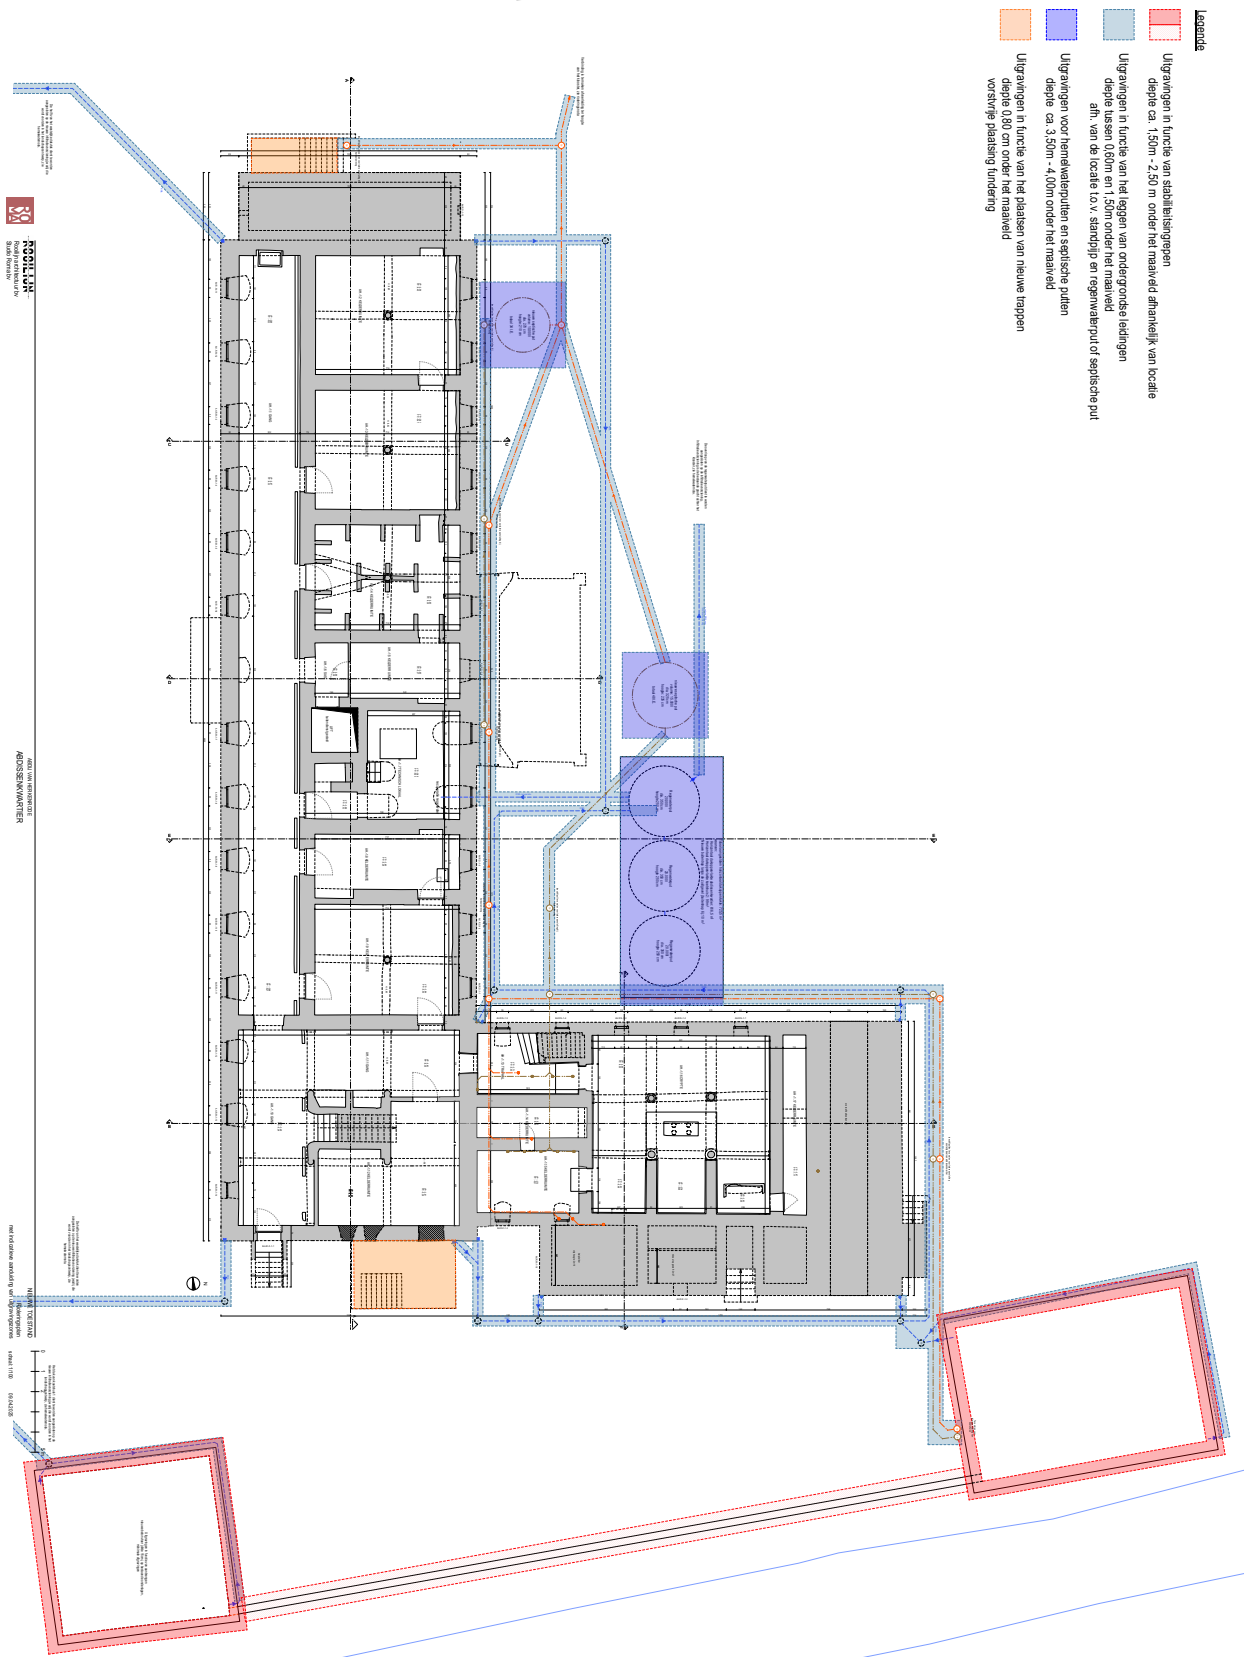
Rioleringsplan met weergave van de geplande uitgravingen (© Studio Roma)
